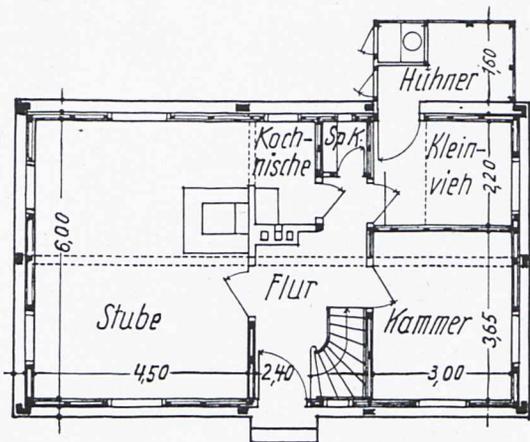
g. Abwandlung des Erdgeschoßgrundrisses.
